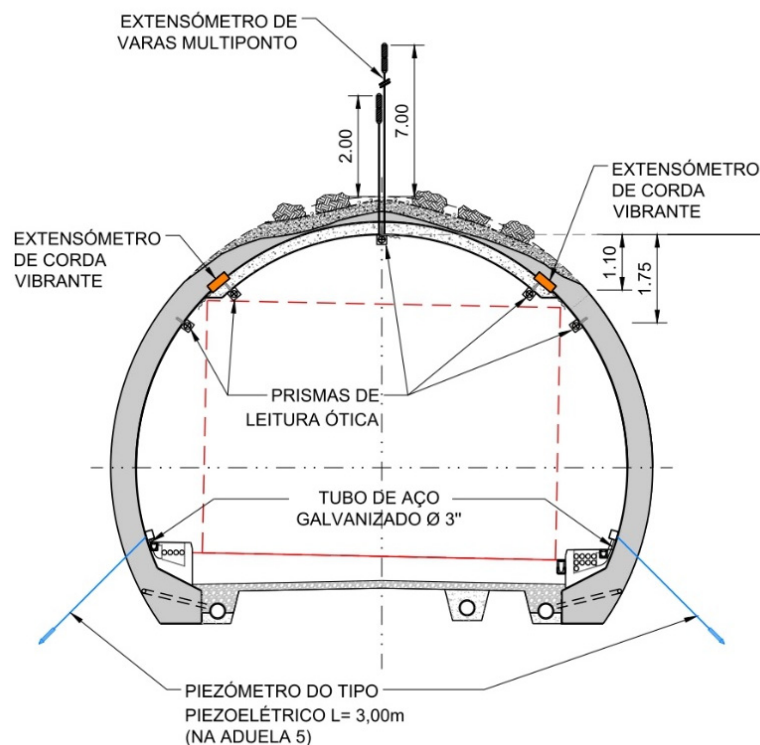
Corte transversal da instrumentação colocada: secção principal e secundária. (Extraído de: Brista Concessão, Brista Construção de Infraestruturas, COBA Portugal – Corte transversal – Galeria Central/Plano de Monitorização, 2021)
